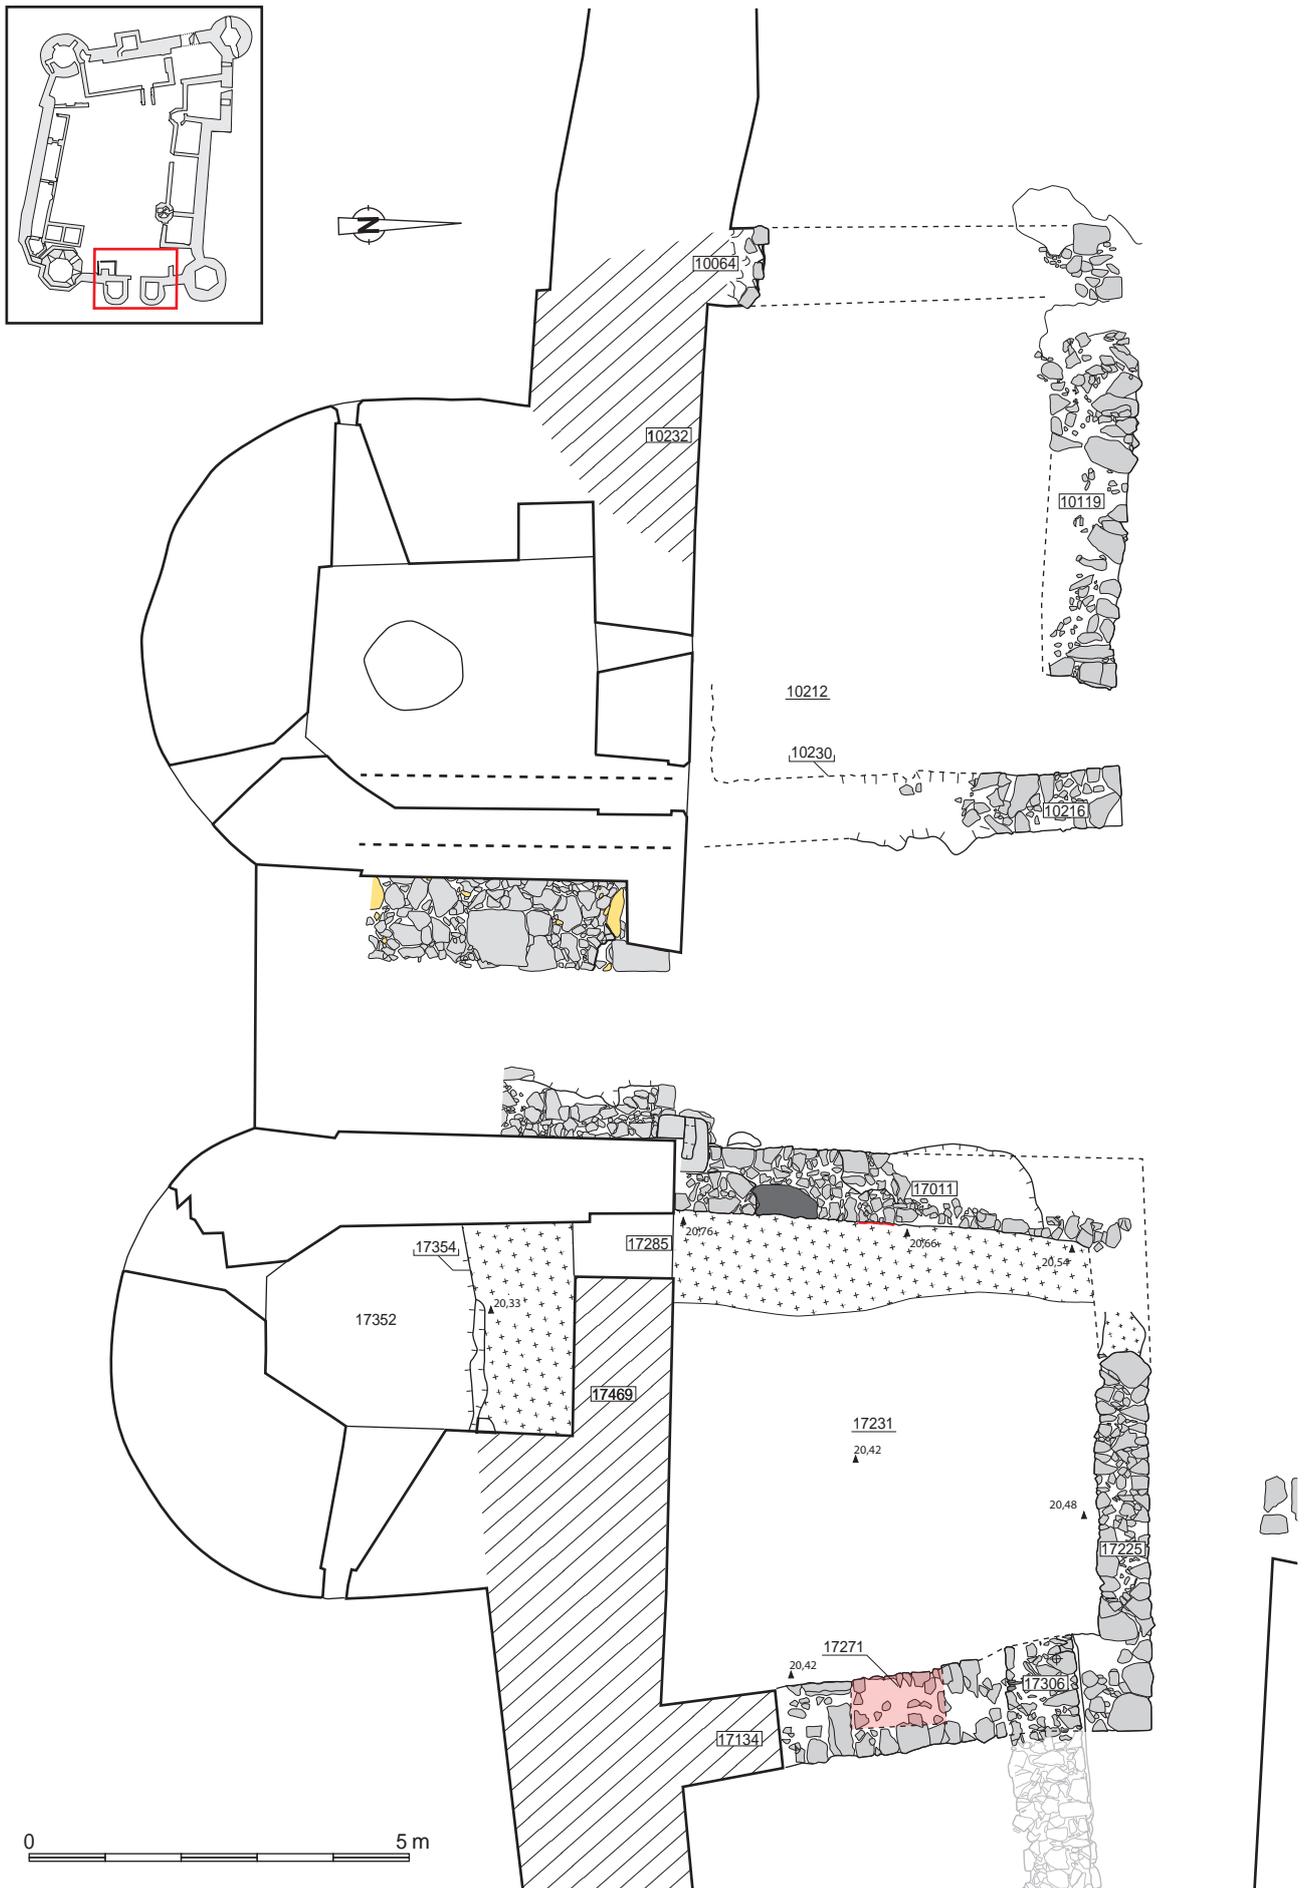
Plan de détail du châtelet. © Laurent Beuchet, Inrap
